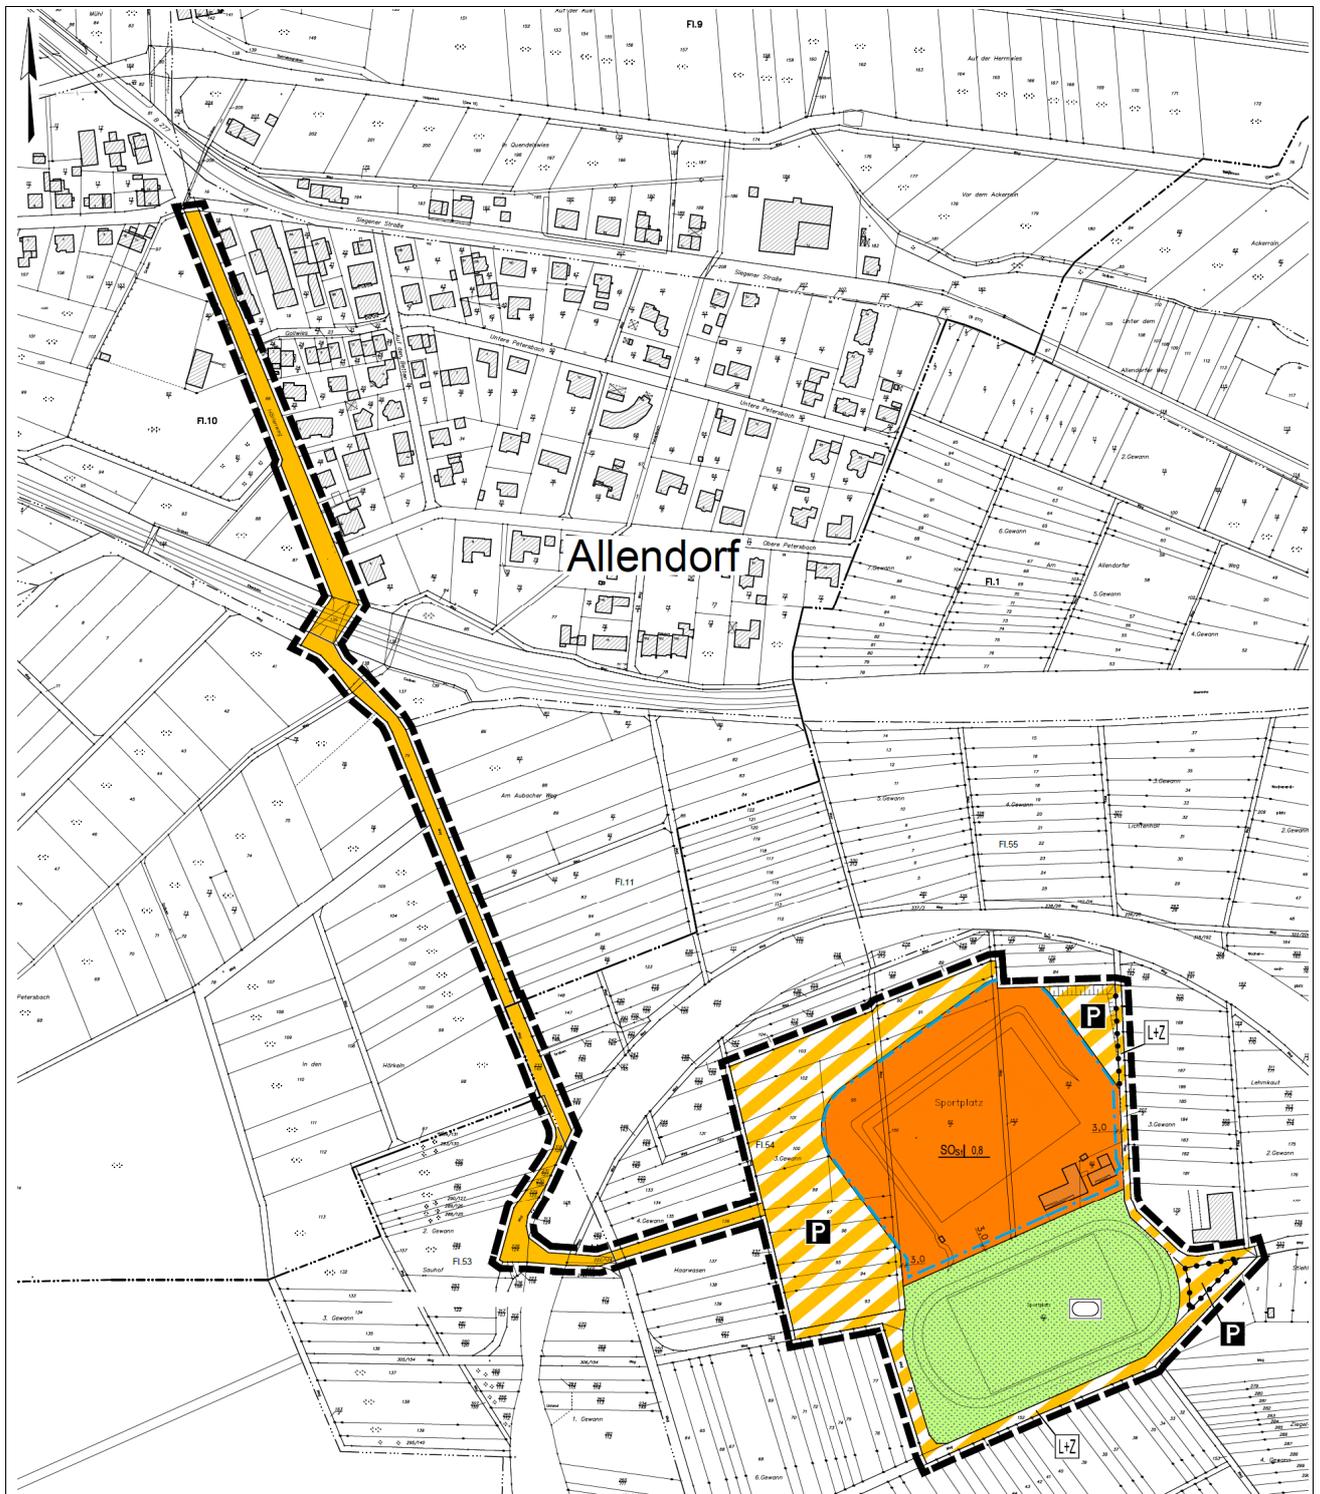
Lageplan des Plangebietes "Erweiterung Sportanlage Haarwasen".
